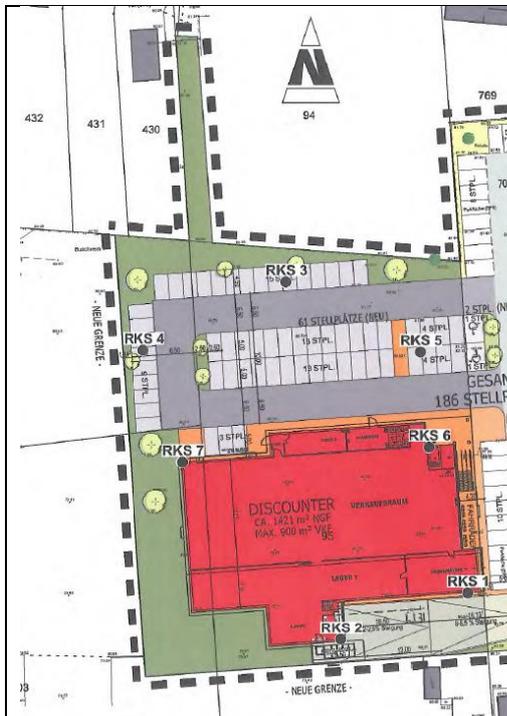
Lageplan mit eingetragenen Bodenaufschlusspunkten
